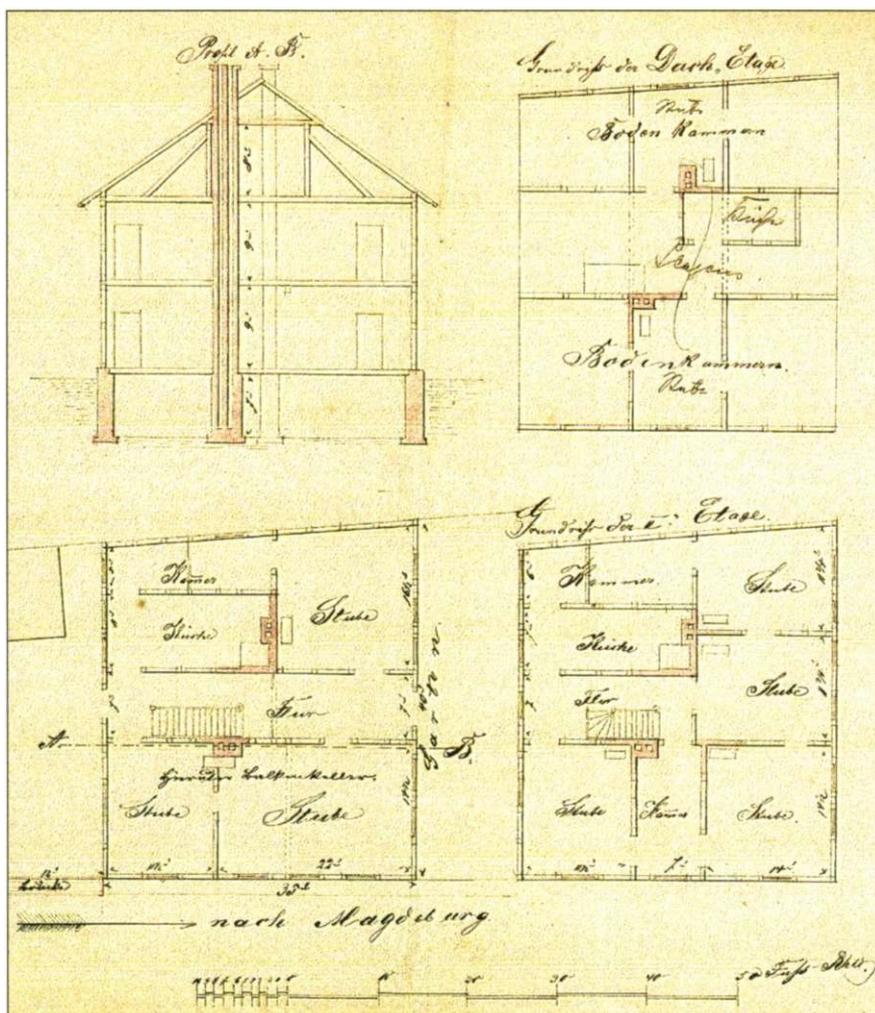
Liebknechtstraße 26, Querschnitt und Grundrisse des 1864 gebauten Wohnhauses
